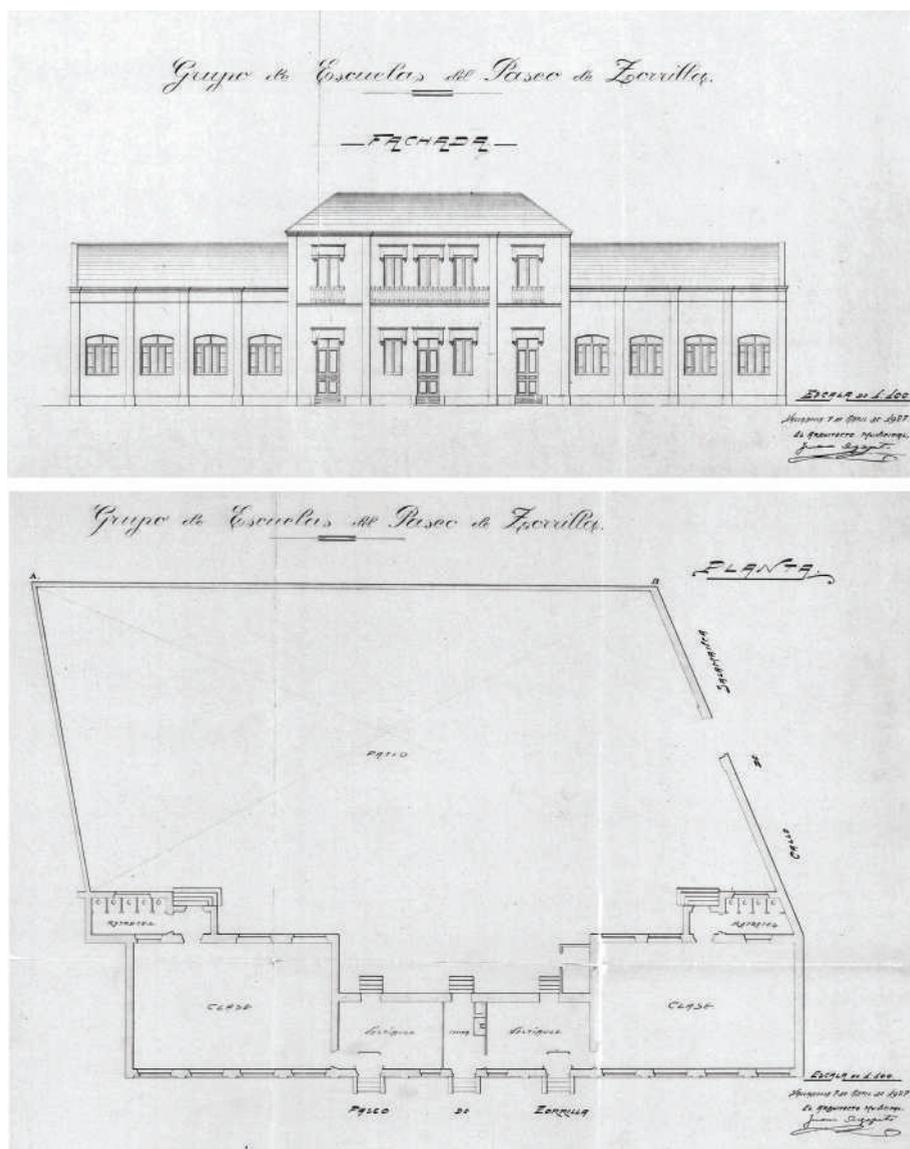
Fachada principal y planta del estado de las escuelas del Paseo de Zorrilla según plano de Juan Agapito y Revilla fechado el 7 de abril de 1927 (Fuente: AMVa, 816-9).
